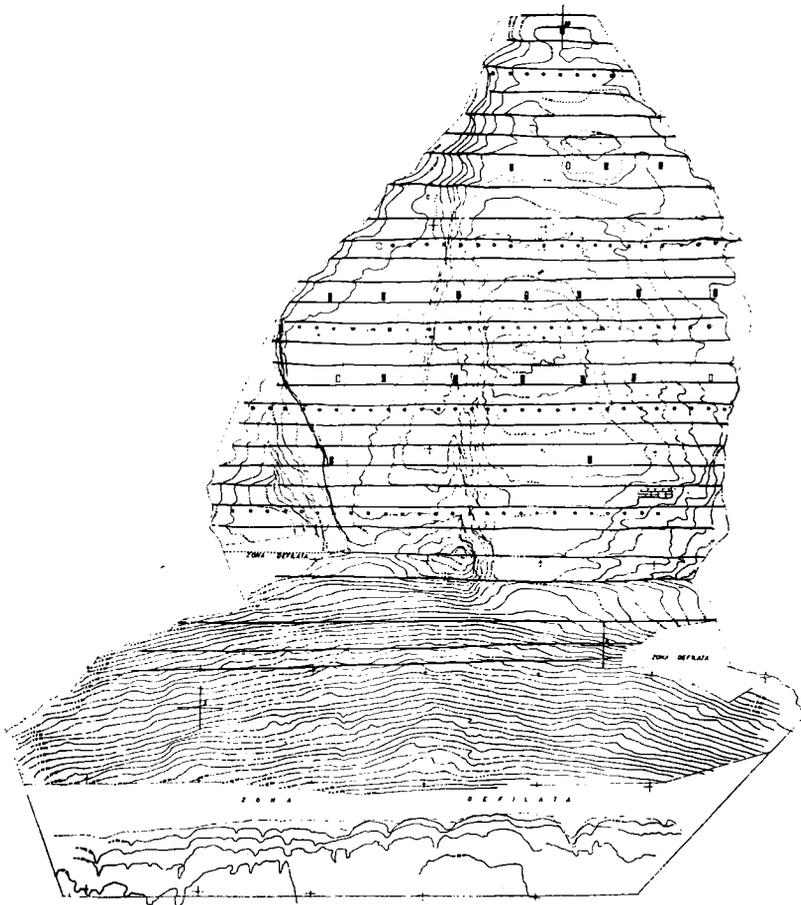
Esempio N. 3: PROSPETTO DI ZIQQURAT
